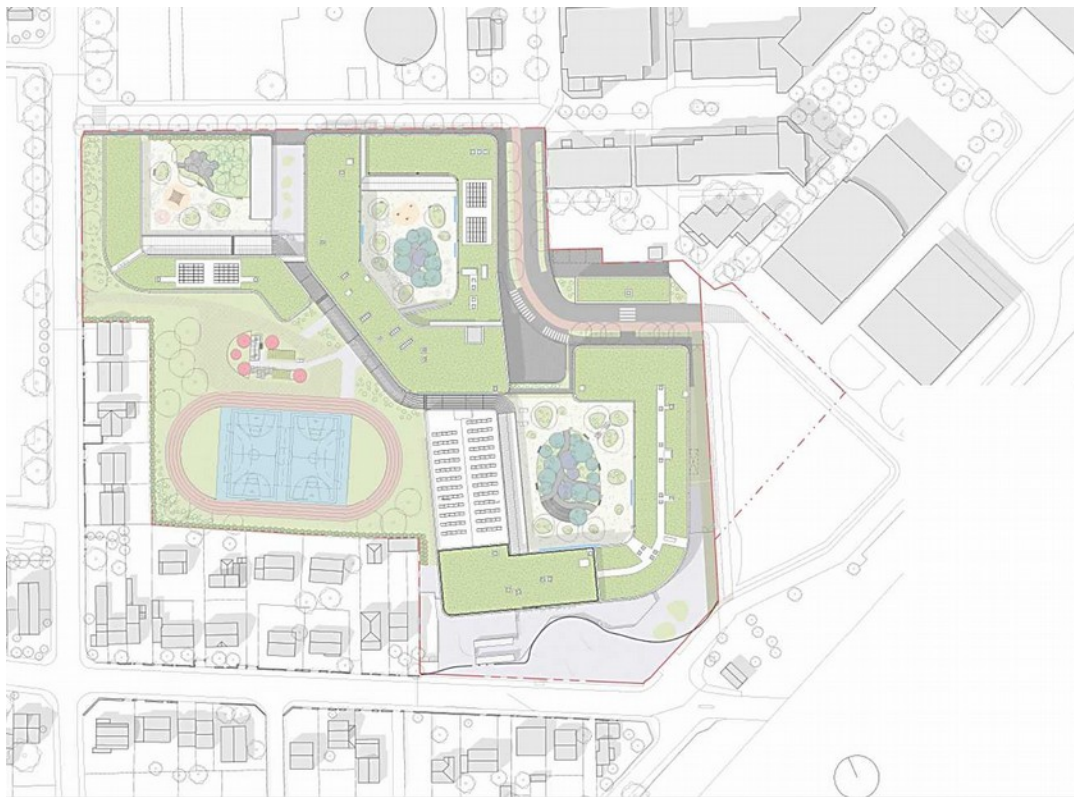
plan masse du projet de la cité scolaire. En haut à droite de l'image, le théâtre de Sartrouville Yves-Lévy. Source : PC, Plan masse.
